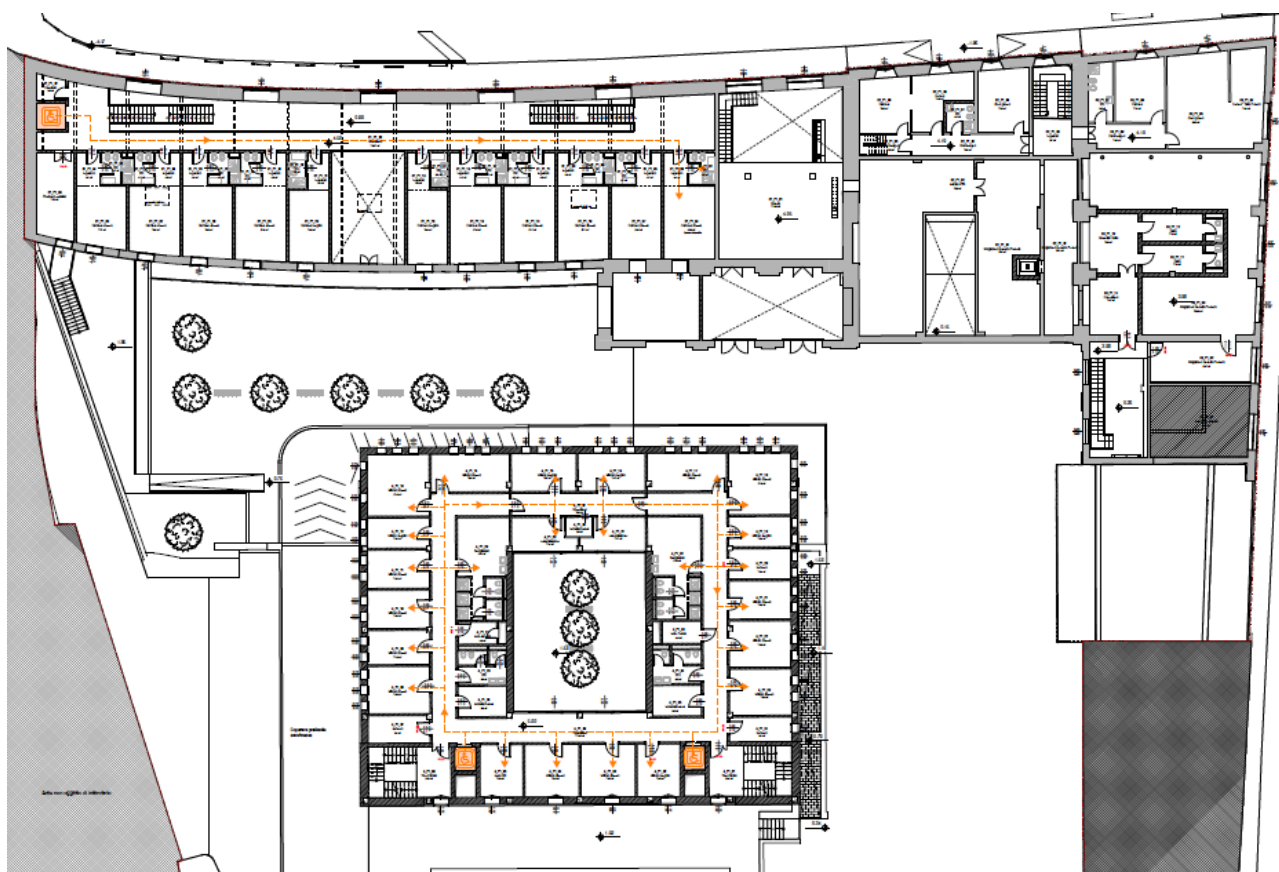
pianta piano primo - estratto della tavola dedicata al superamento delle barriere architettoniche
